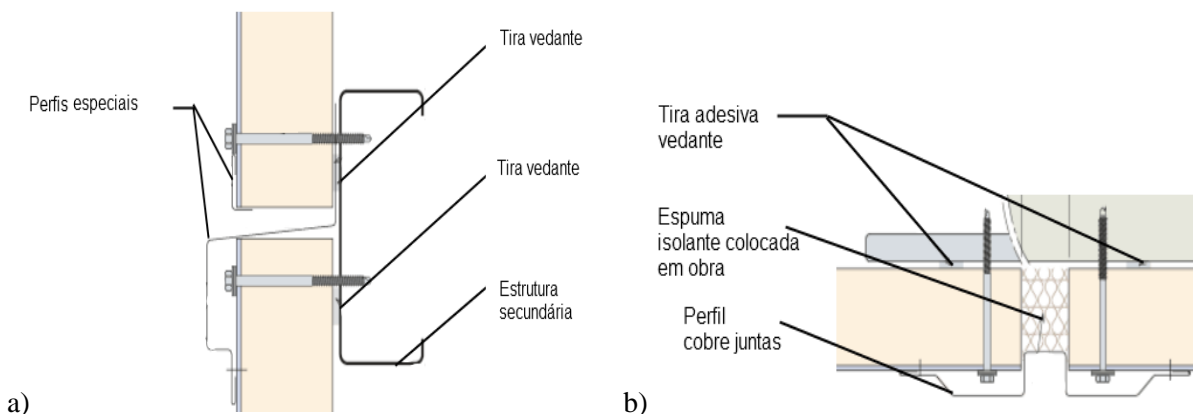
Juntas entre painéis: a) Junta horizontal, b) junta vertical. Adaptado de [84].
